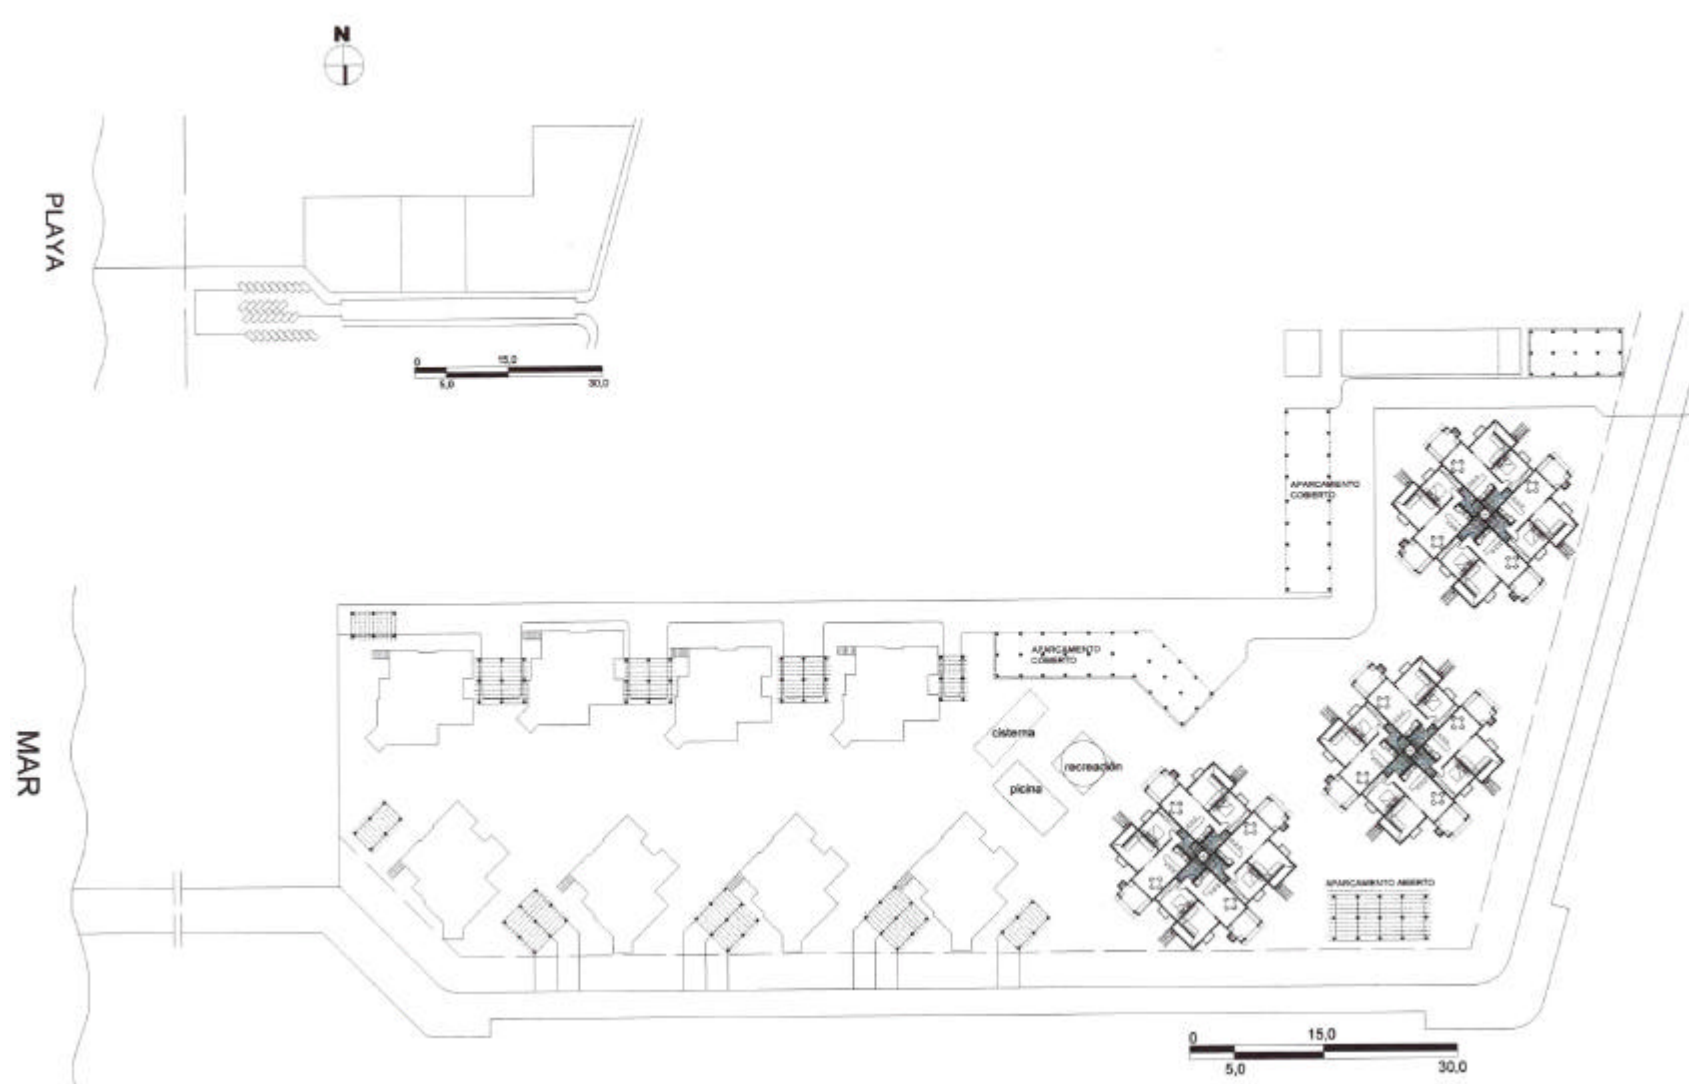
Condominio Portezuelo. Planta de Situación y emplazamiento de los bloques en el terreno. (F.: Arq. Brena)
